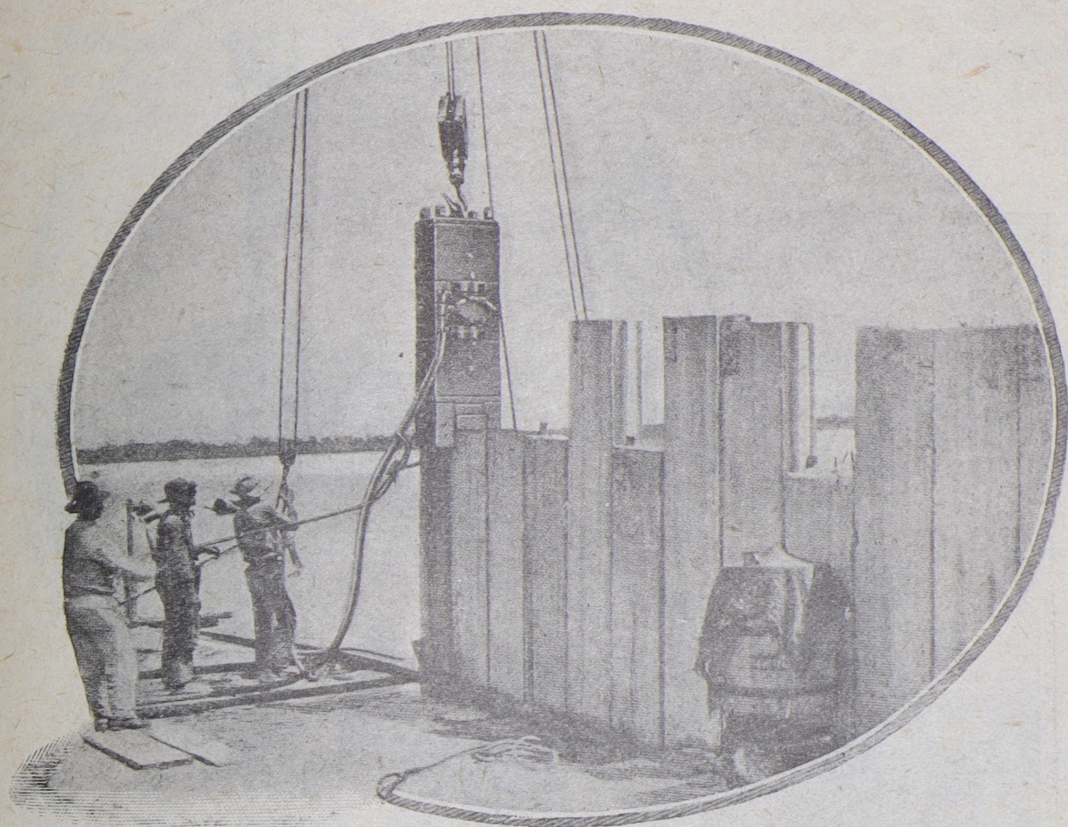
Забивка железобетонных свай молотом 9-В-5. Молот установлен в шахте, поддерживаемой 3-мя растяжками и краном.
